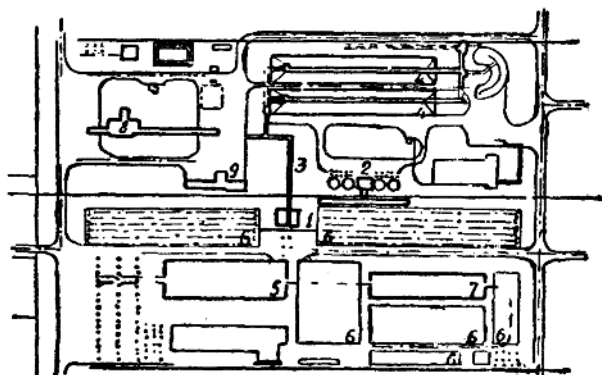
混凝土、砂漿和鋼筋混凝土制品工厂总平面示意图
